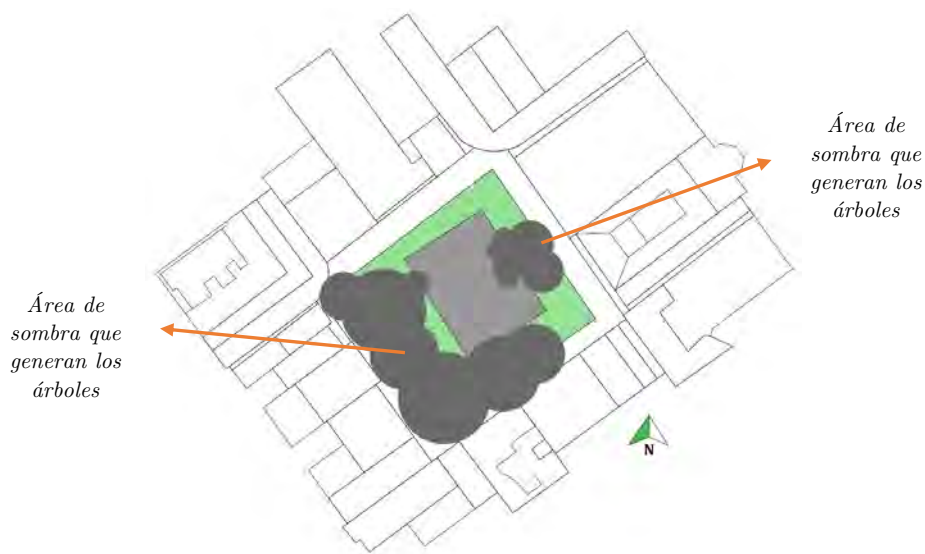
Redibujado en planta de la Plaza de la Concordia y la superficie de sombra que generan los árboles que se encuentran plantados ahí. Fuente: Autora.
